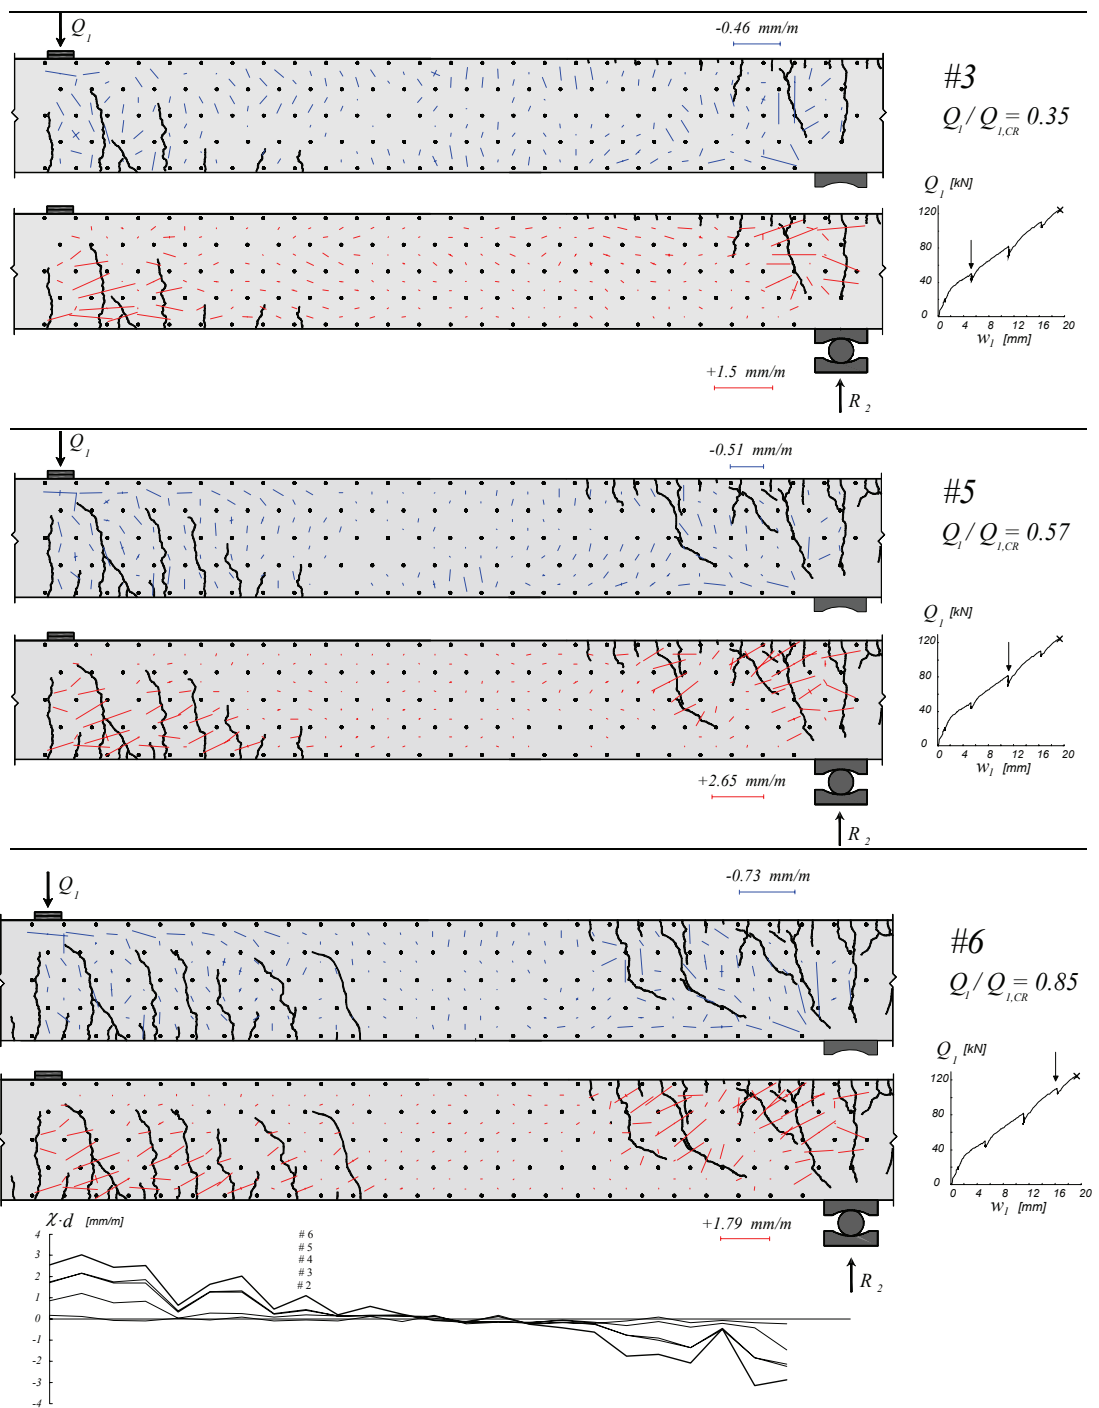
Poutre SR2: déformations principales, fissuration et courbures
